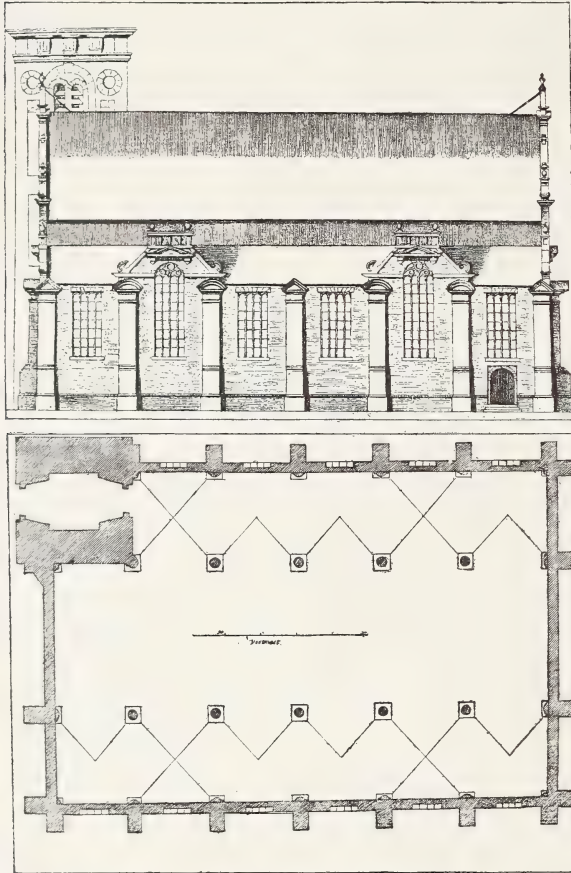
Grundriß u. Seitenansicht d. Zuider-Kirche zu Amsterdam.
